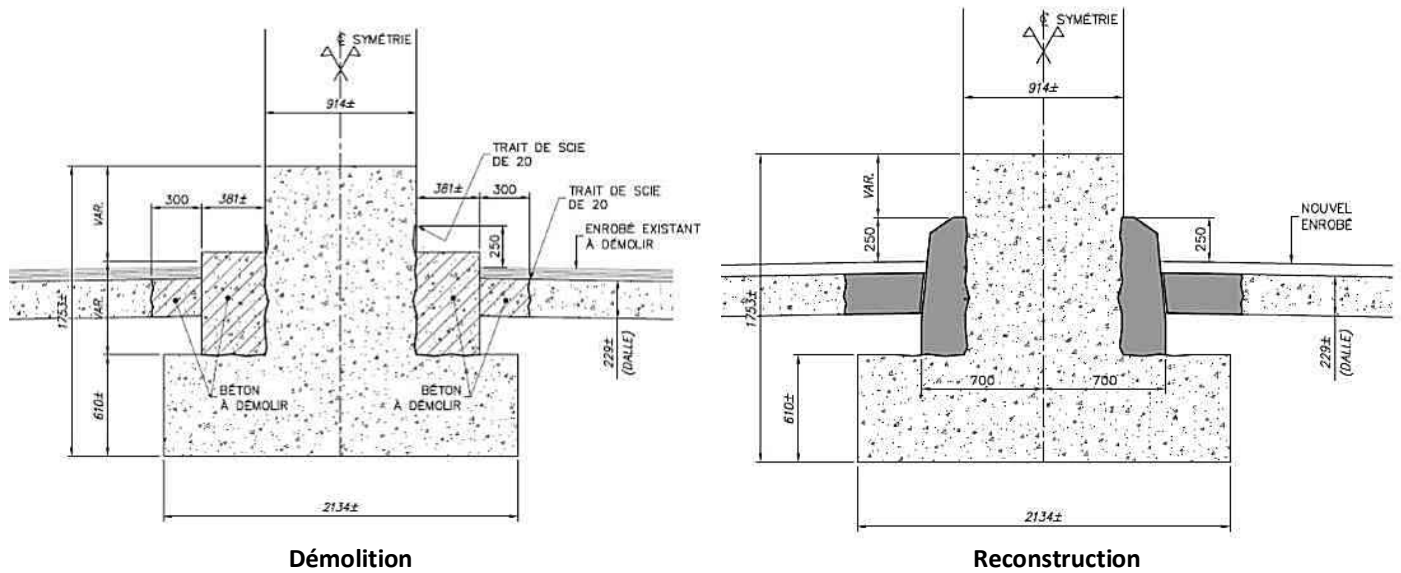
Pont ferroviaire – Reconstruction du chasse-roue à la pile
